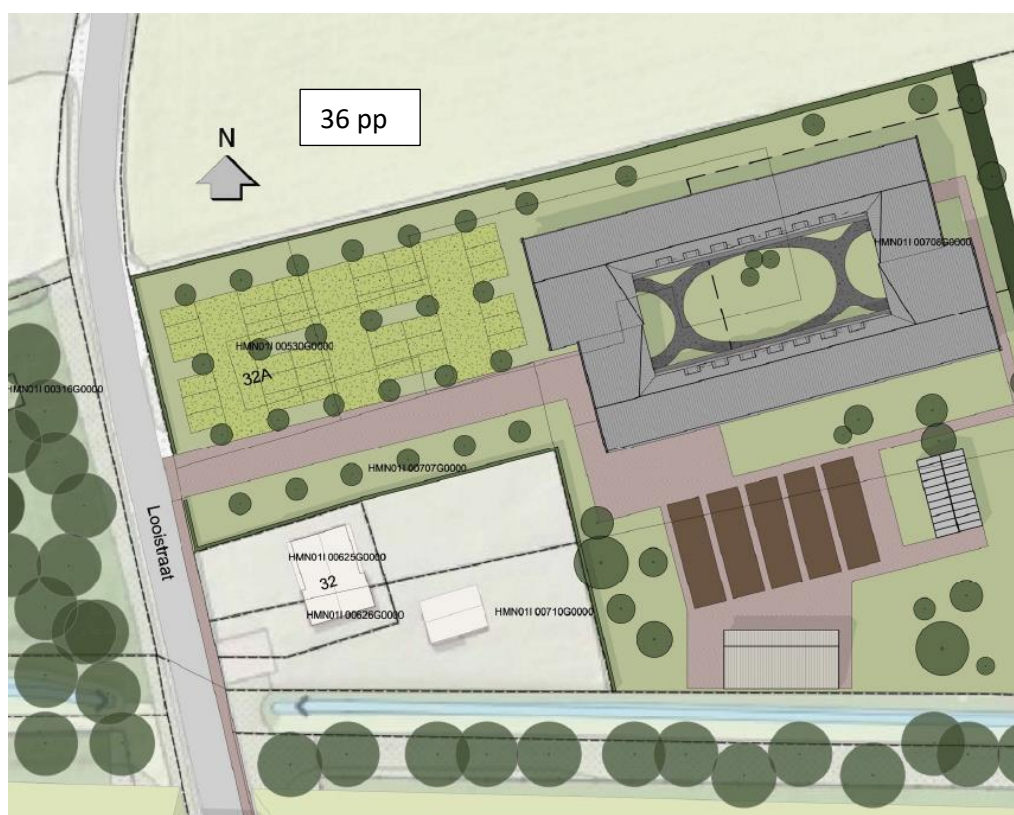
impressie bebouwing [Croonen Architecten]
